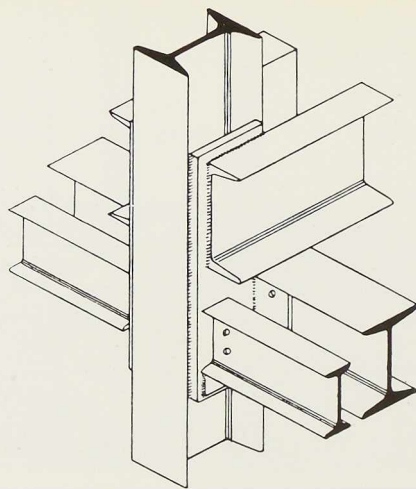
Assemblage des poteaux nord avec les entretoises et les poutres porte-mur.
